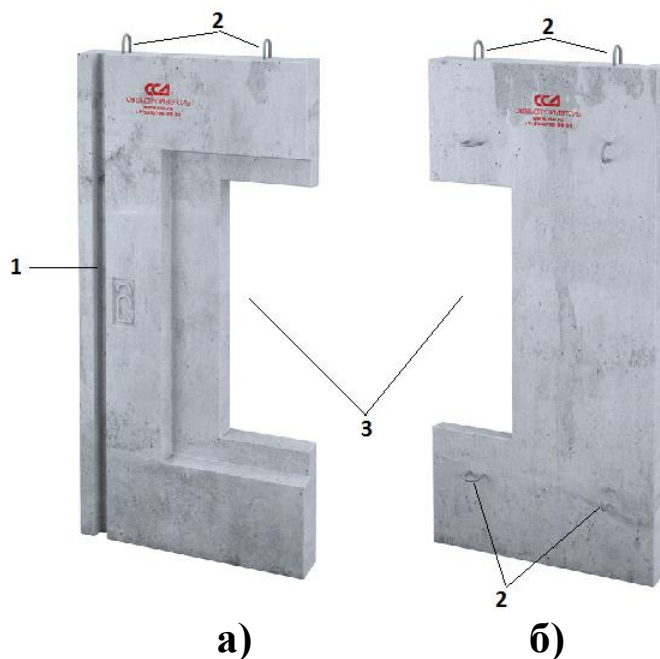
Внешний вид и детали блока «СБ-3-1»:
